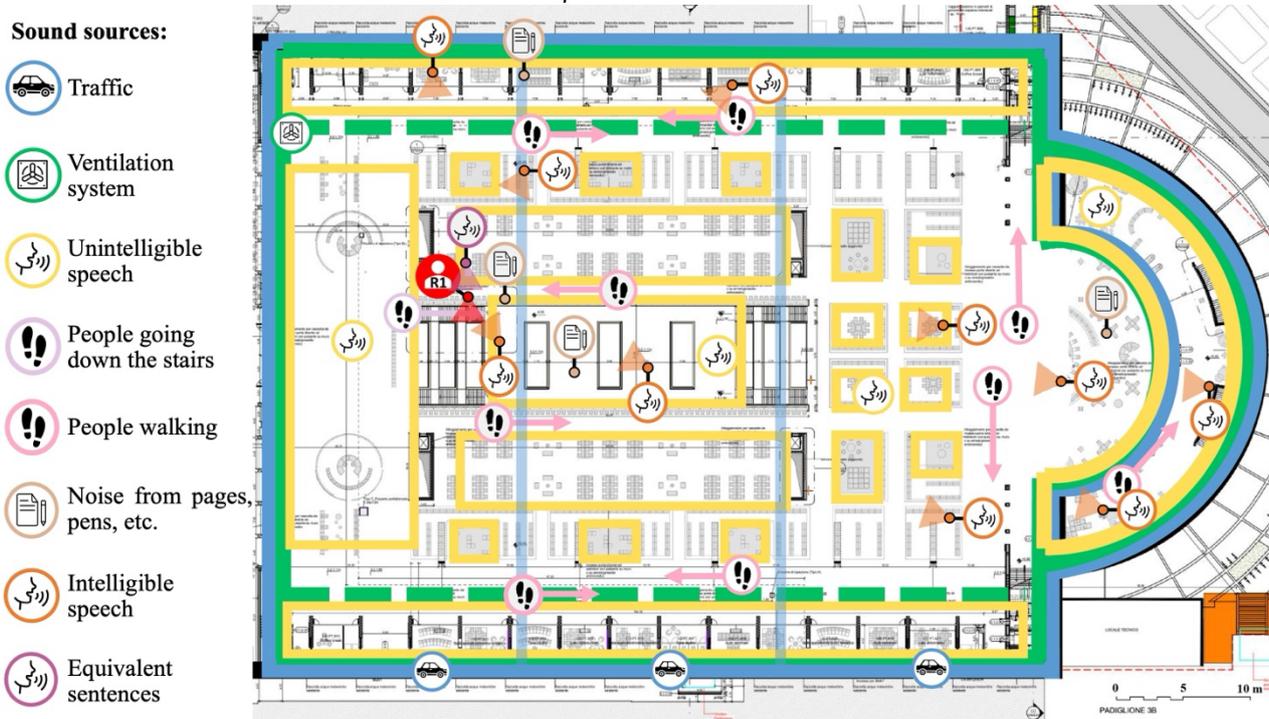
Planimetria della biblioteca con il posizionamento delle diverse sorgenti sonore.
